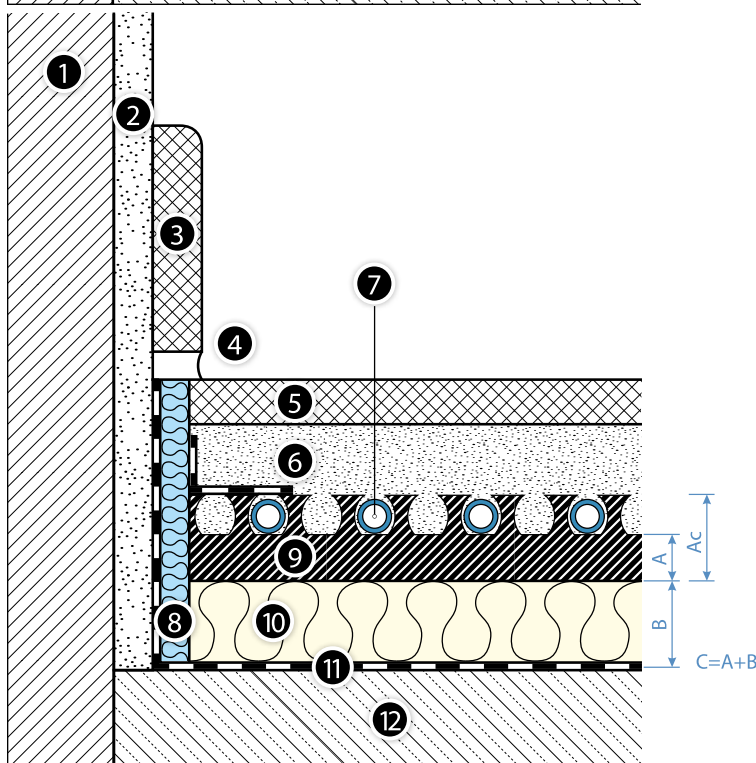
Плита панельного опалення/охолодження в системі KAN-therm Profil з додатковою ізоляцією, а також гідроізоляційним покриттям на перекритті, що лежить на ґрунті.
